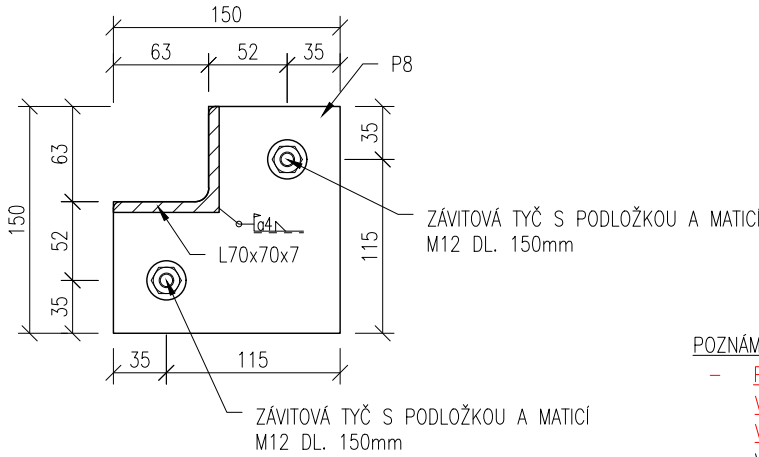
NADPRAŽÍ ŠACHETNÍCH DVEŘÍ
